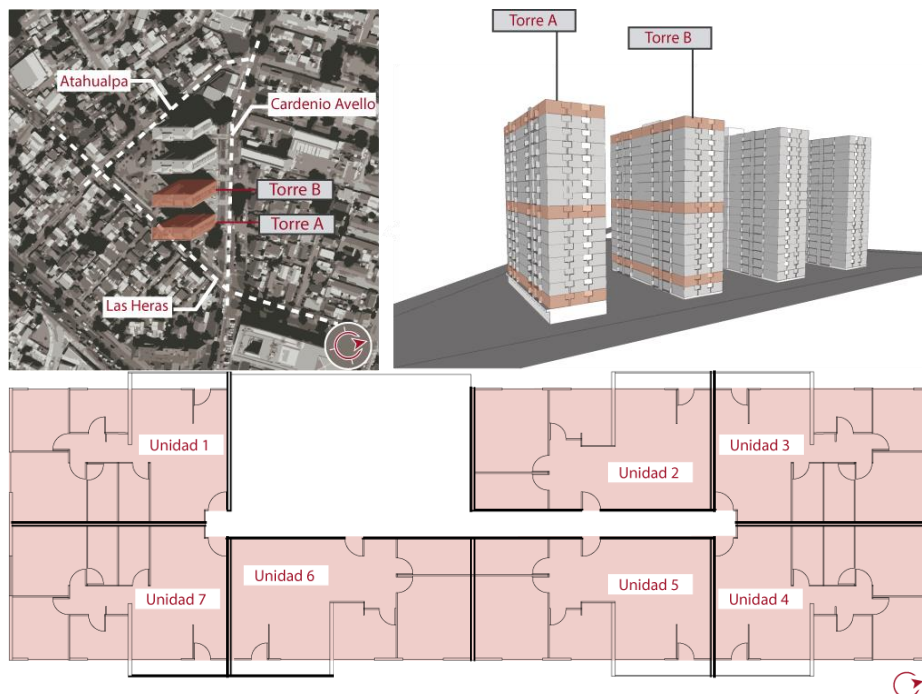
Vista en planta del conjunto residencial de torres y su contexto inmediato (izquierda) y modelos identificando las torres A y B (derecha). Planta tipo (abajo)
